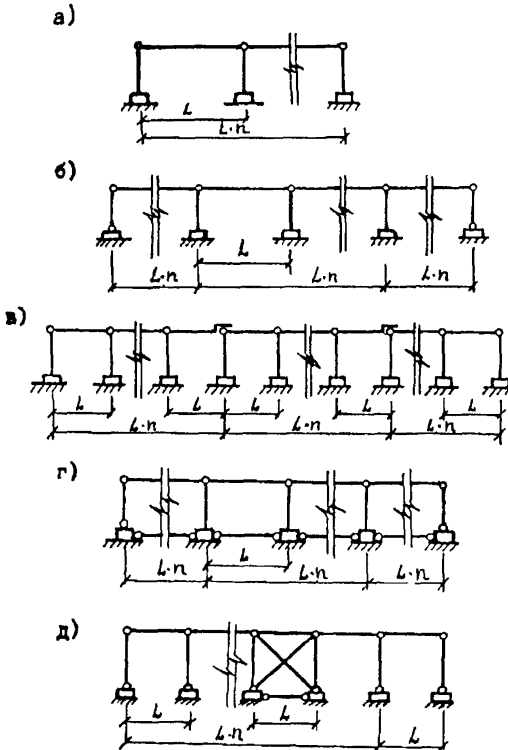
Схемы поперечных рам одноэтажных каркасных зданий
